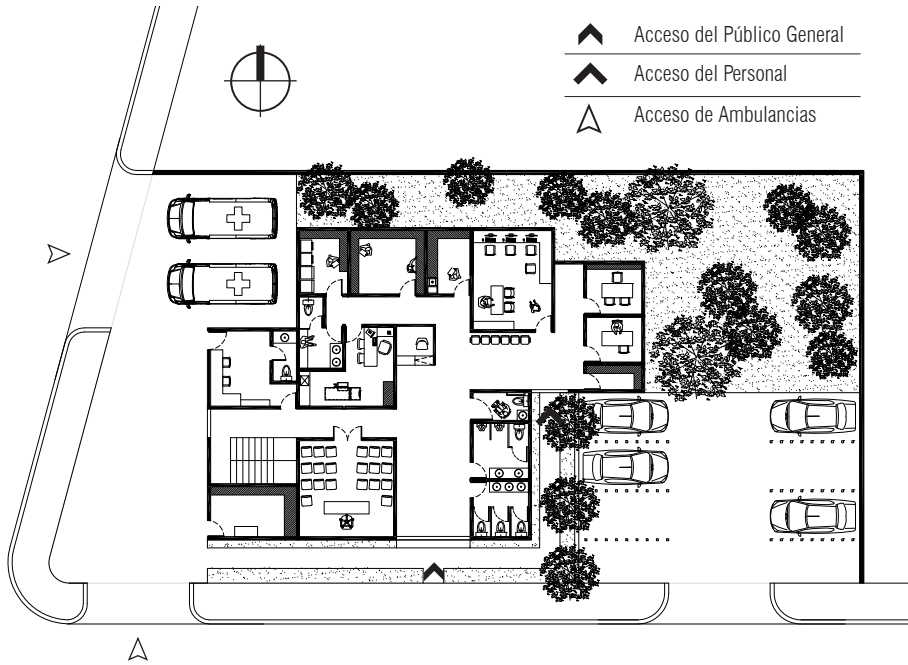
| Prototipo Delegación Básica para el grupo climático tres | Planta Baja
